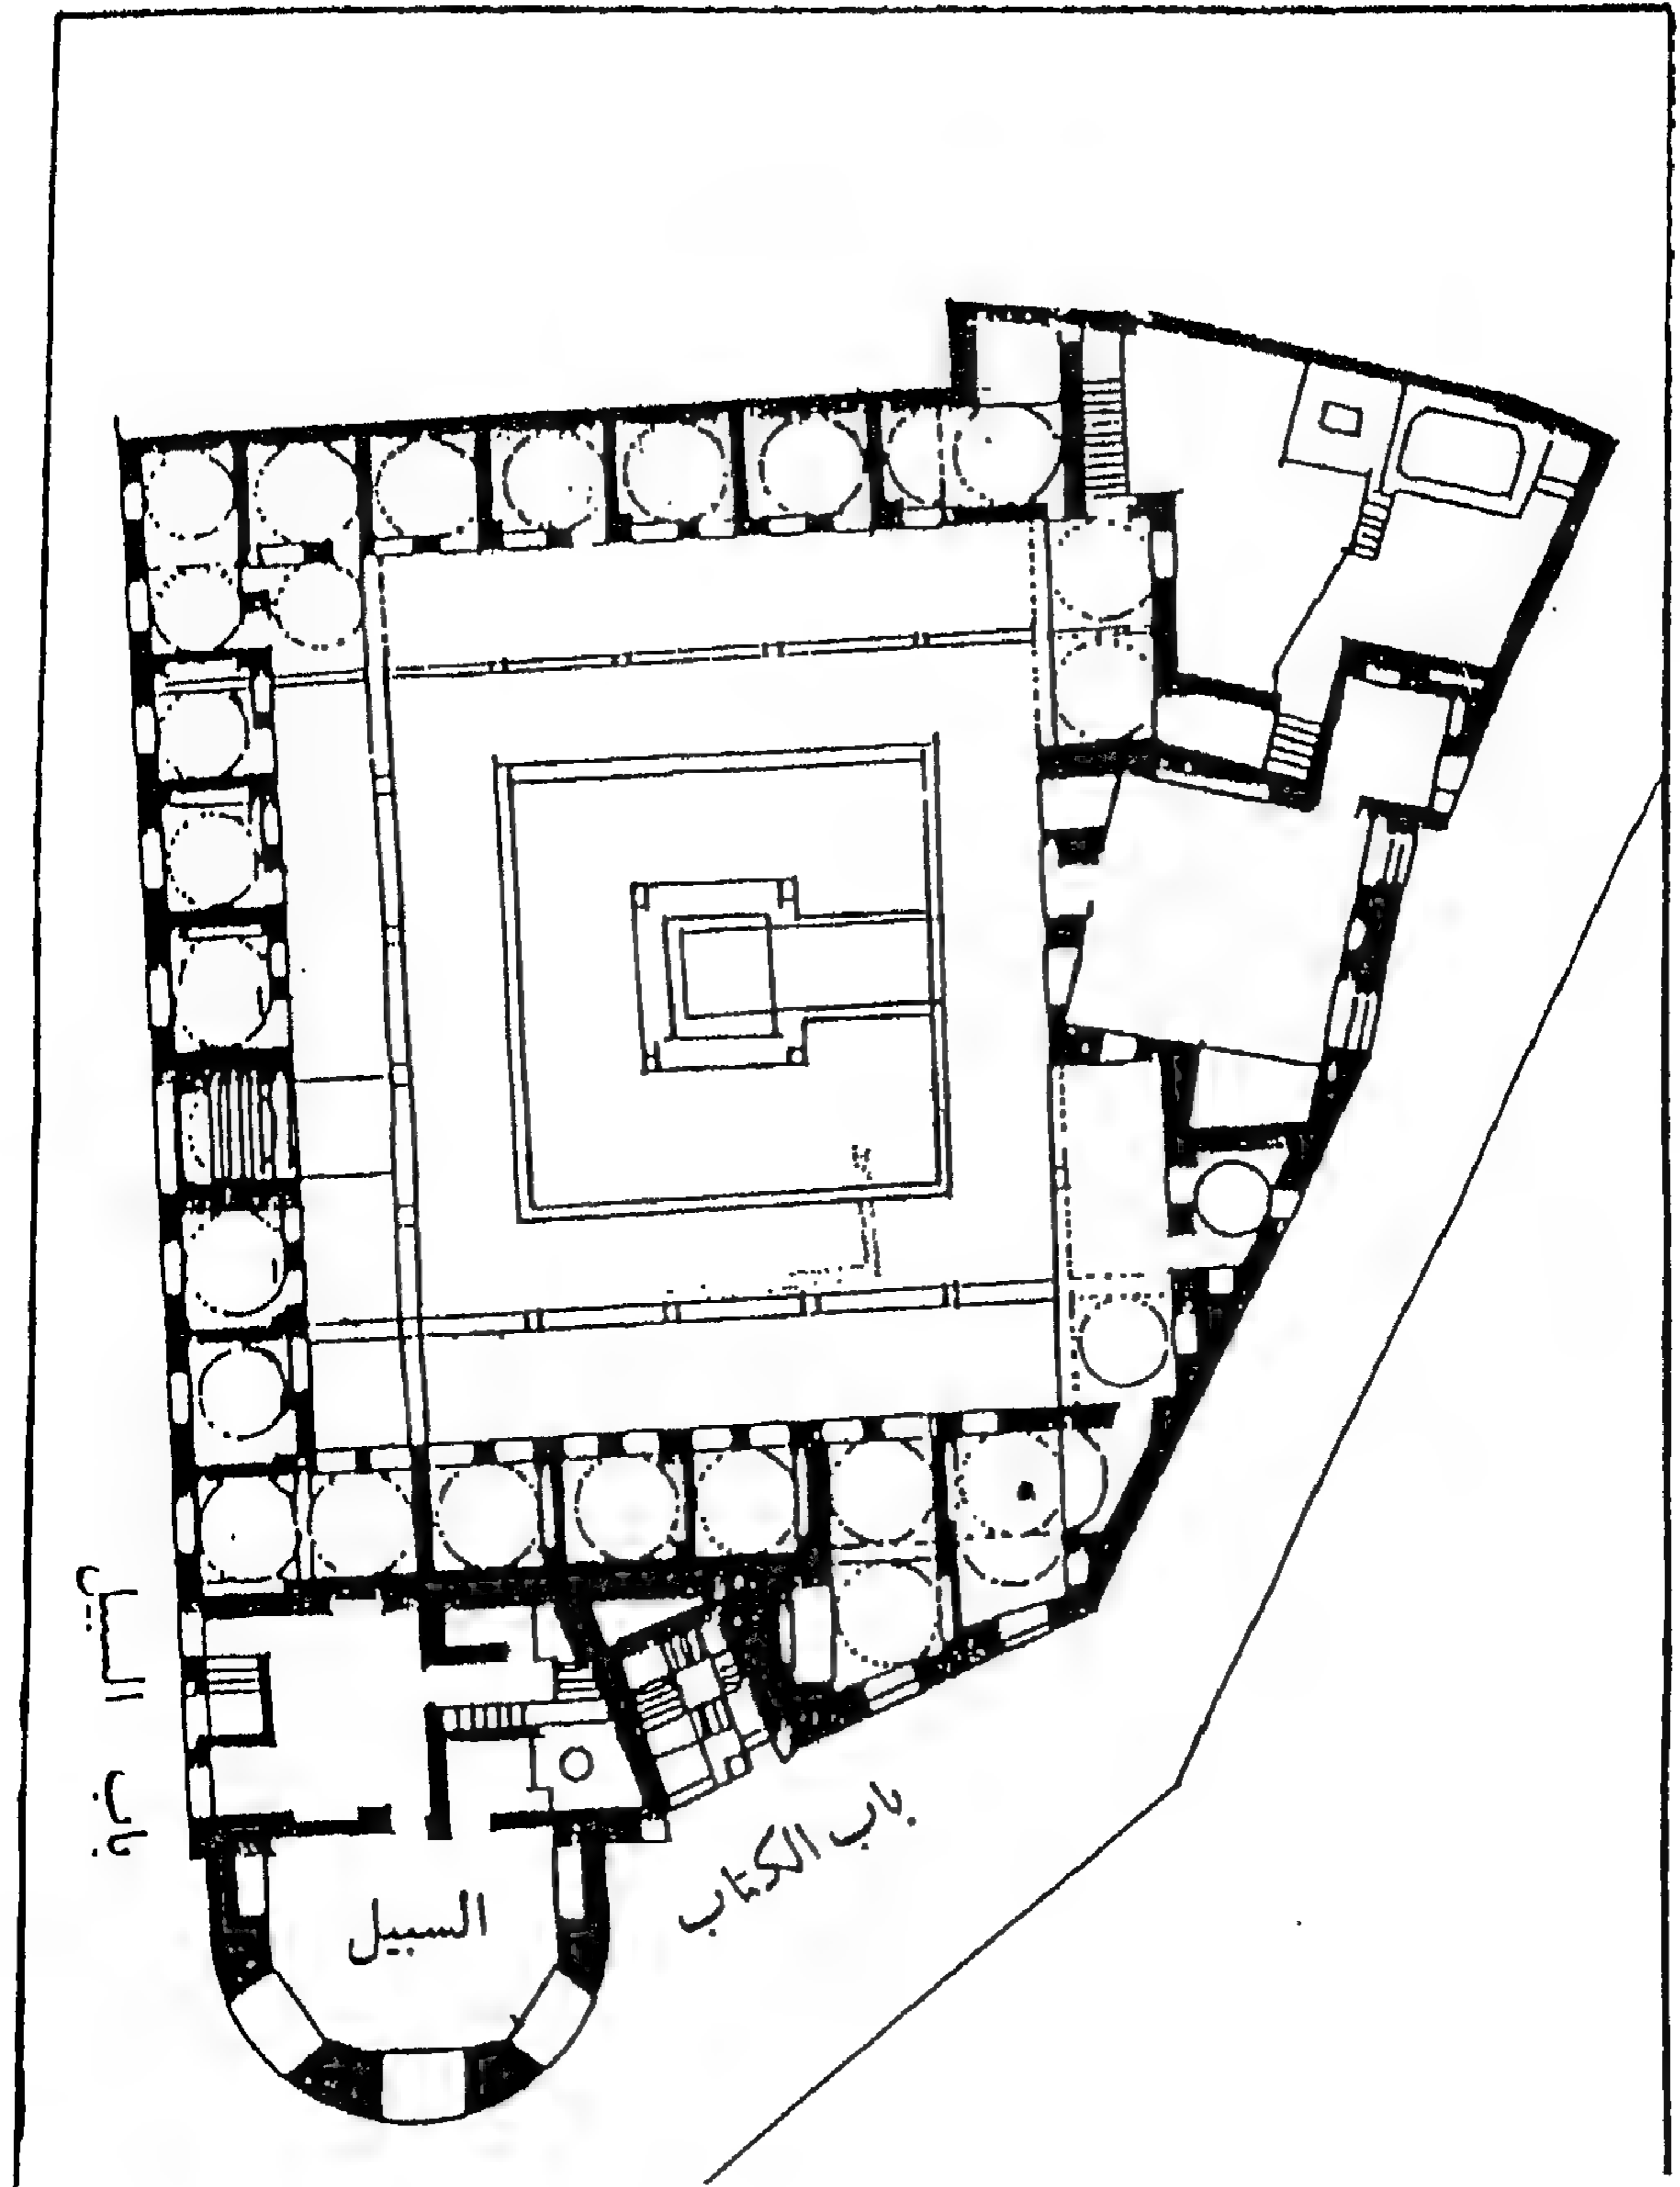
مسقط أفقي لجامع الملكة صفية بالقاهرة .
